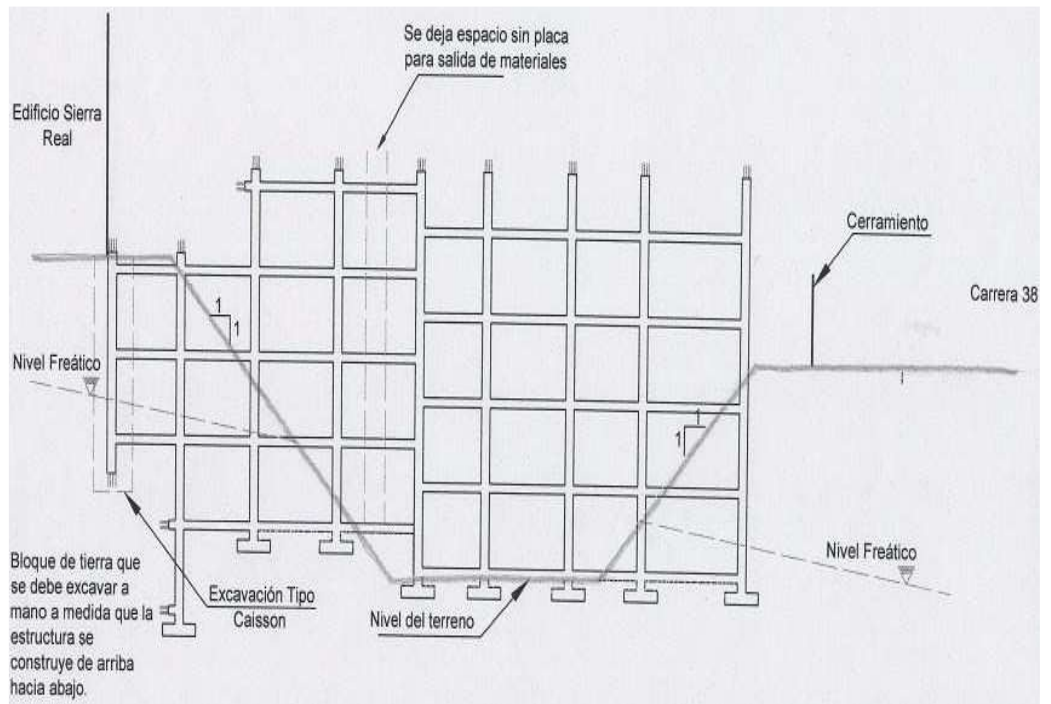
Diagrama 8 Construcción cimentación, Estudio geotécnico de suelo.
